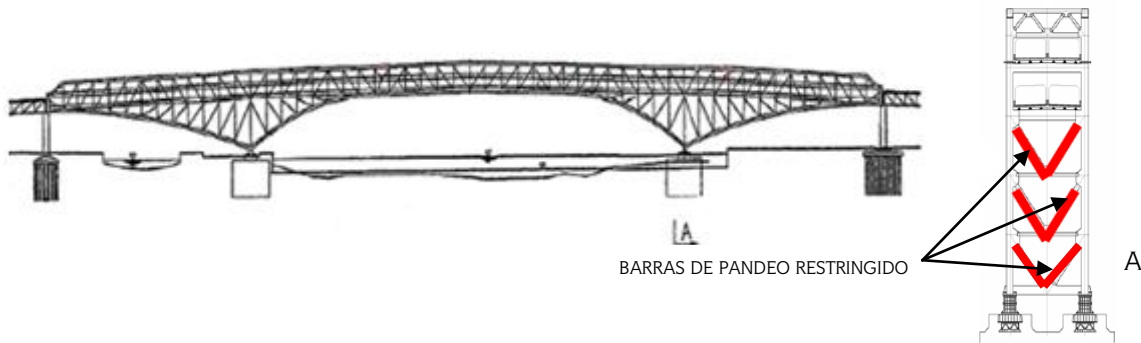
Elevación del Puente “Minato” y corte transversal A con ubicación de barras de pandeo restringido
